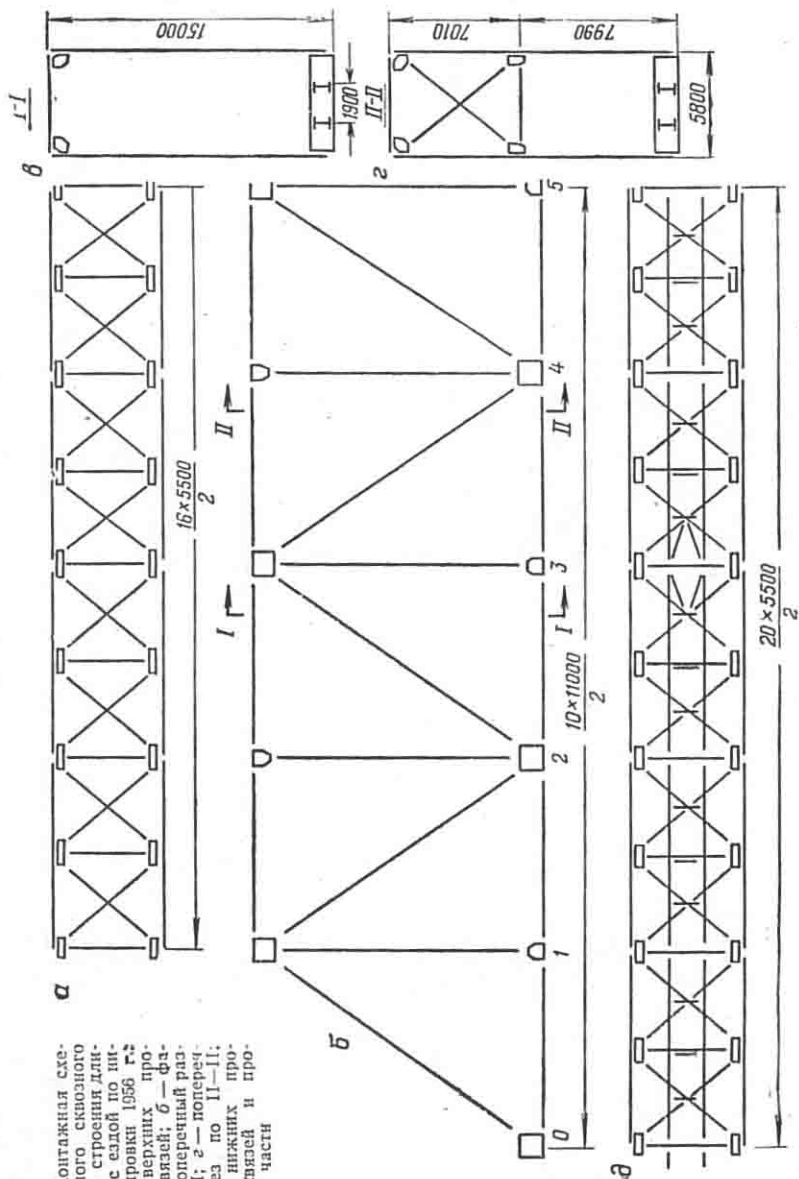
Монтажная схема вклепаного сквозного продольного строения длиной 110 м с садой по плану проектировки 1956 г. а — план верхних продольных связей; б — фасад; в — поперечный разрез по I—I; г — поперечный разрез по II-II; д — план нижних продольных связей и проезжей части
